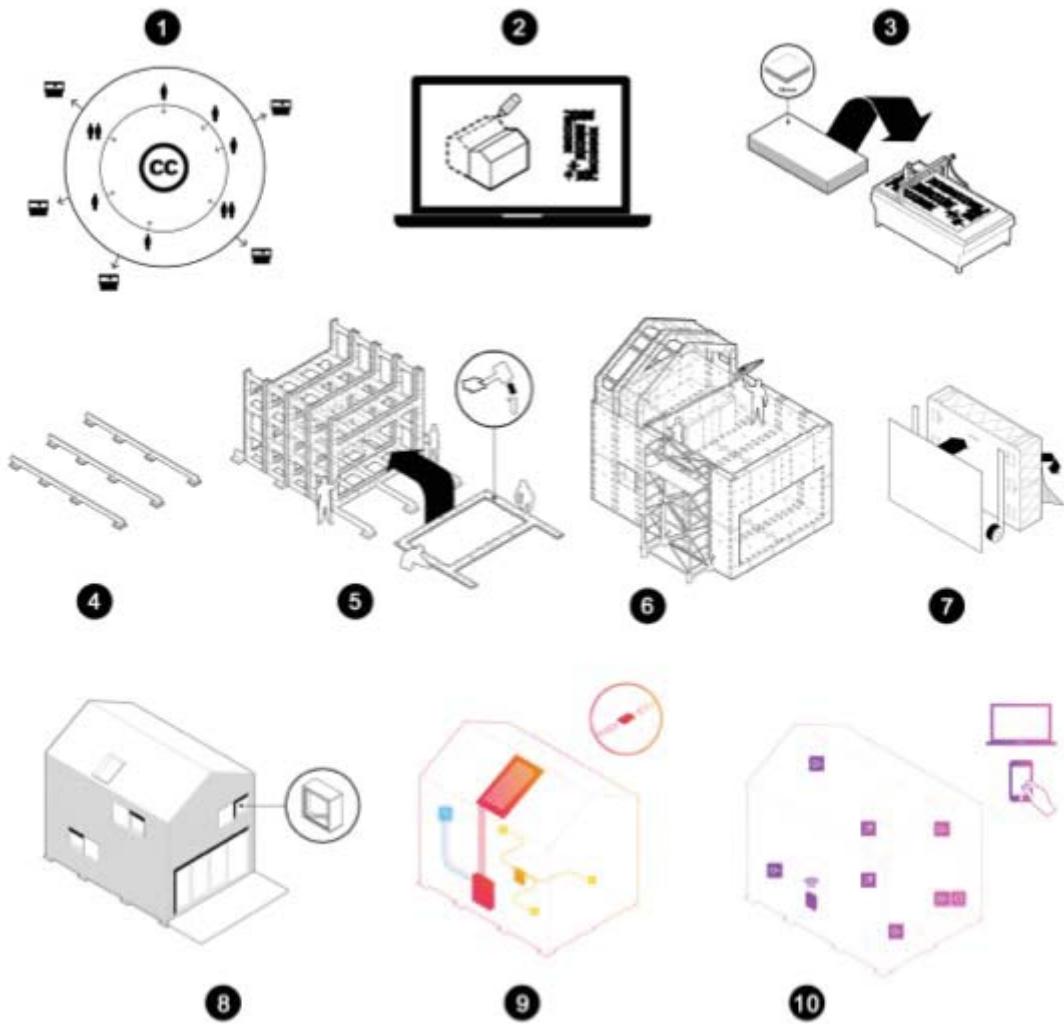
Proceso de construcción del prototipo de vivienda WikiHouse
